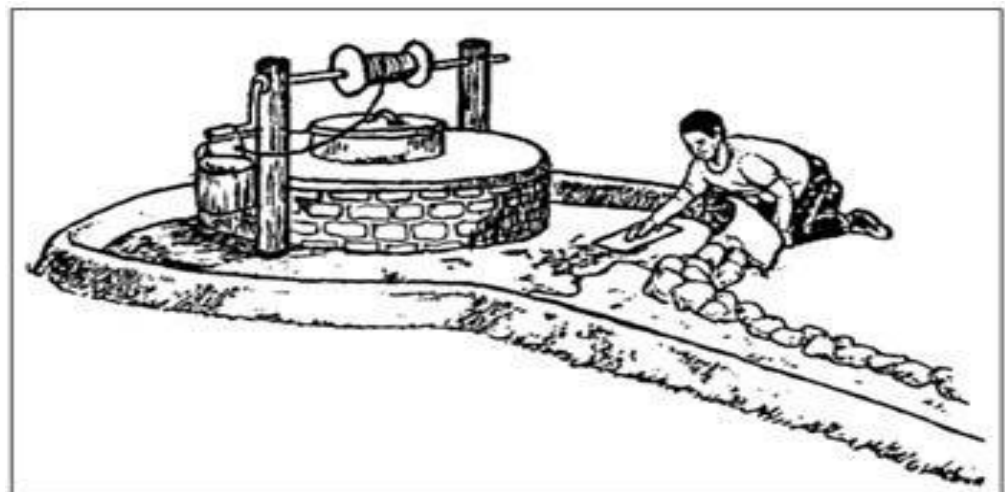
Construction d'un revêtement cimenté des abords d'un puits
